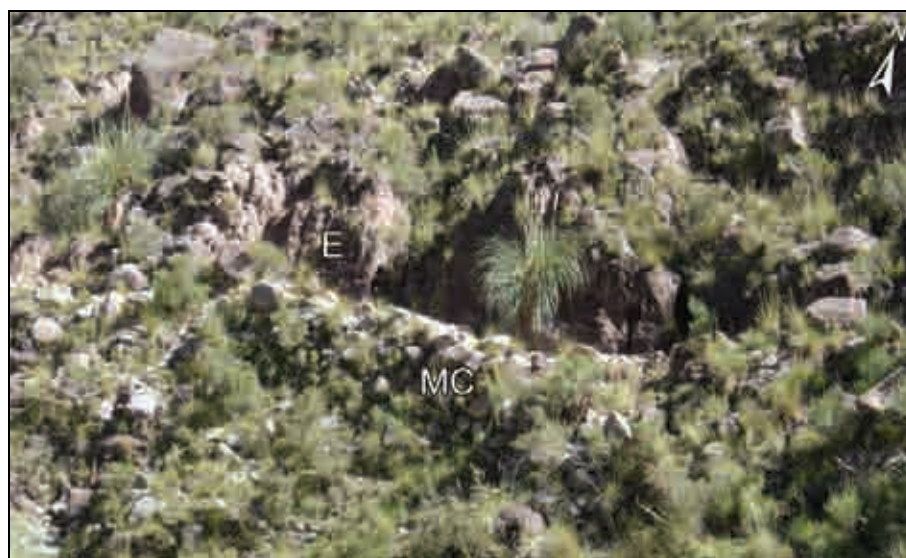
Otro segmento del camino con talud y excavación que desciende del Abra de La Ramadita: MC= muro de contención o talud ladera abajo; E= excavación dentro de la ladera. Fotografía del autor.
